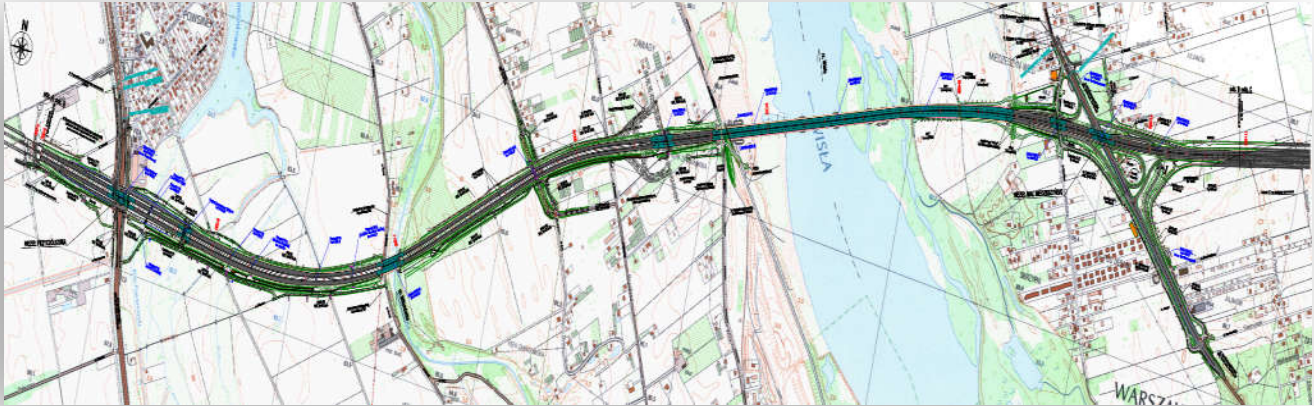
vista en planta de proyecto (Gulermak Poland)
